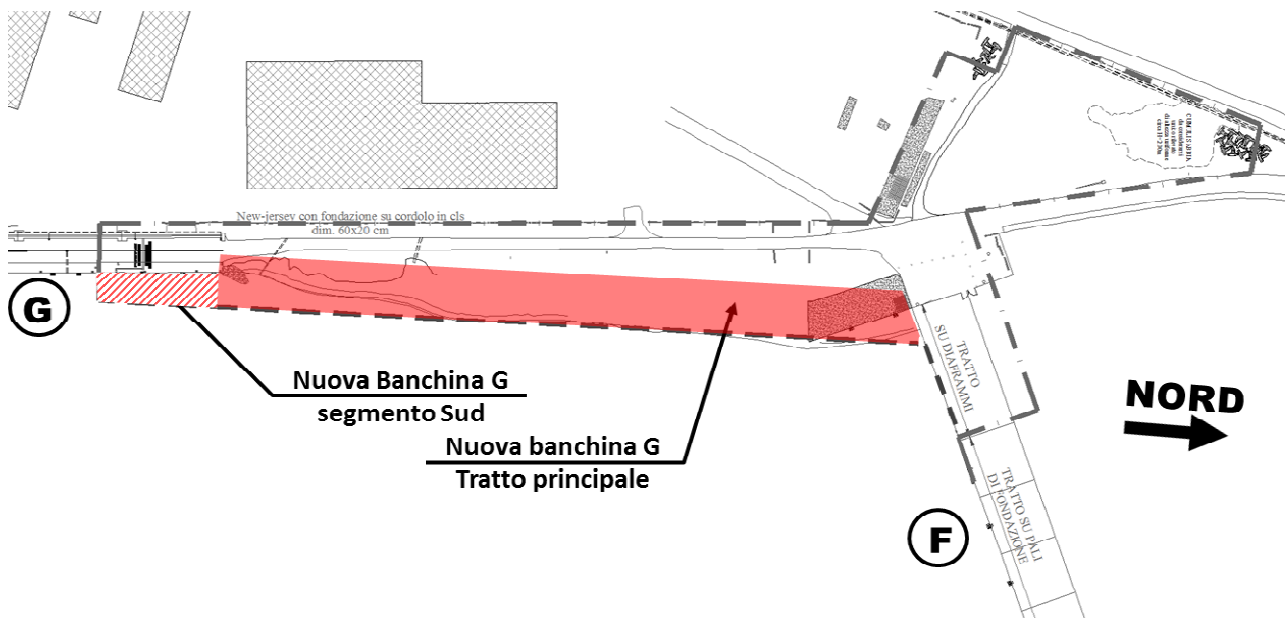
Planimetria dell'area di interesse con l'indicazione dell'intervento
